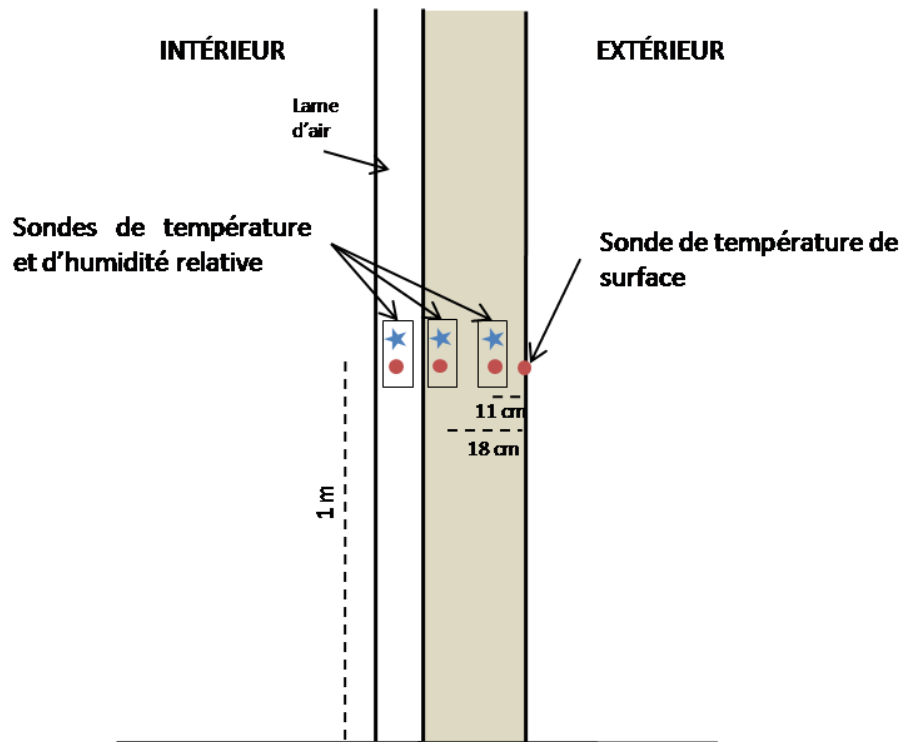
Plan de l'instrumentation de la paroi Est
